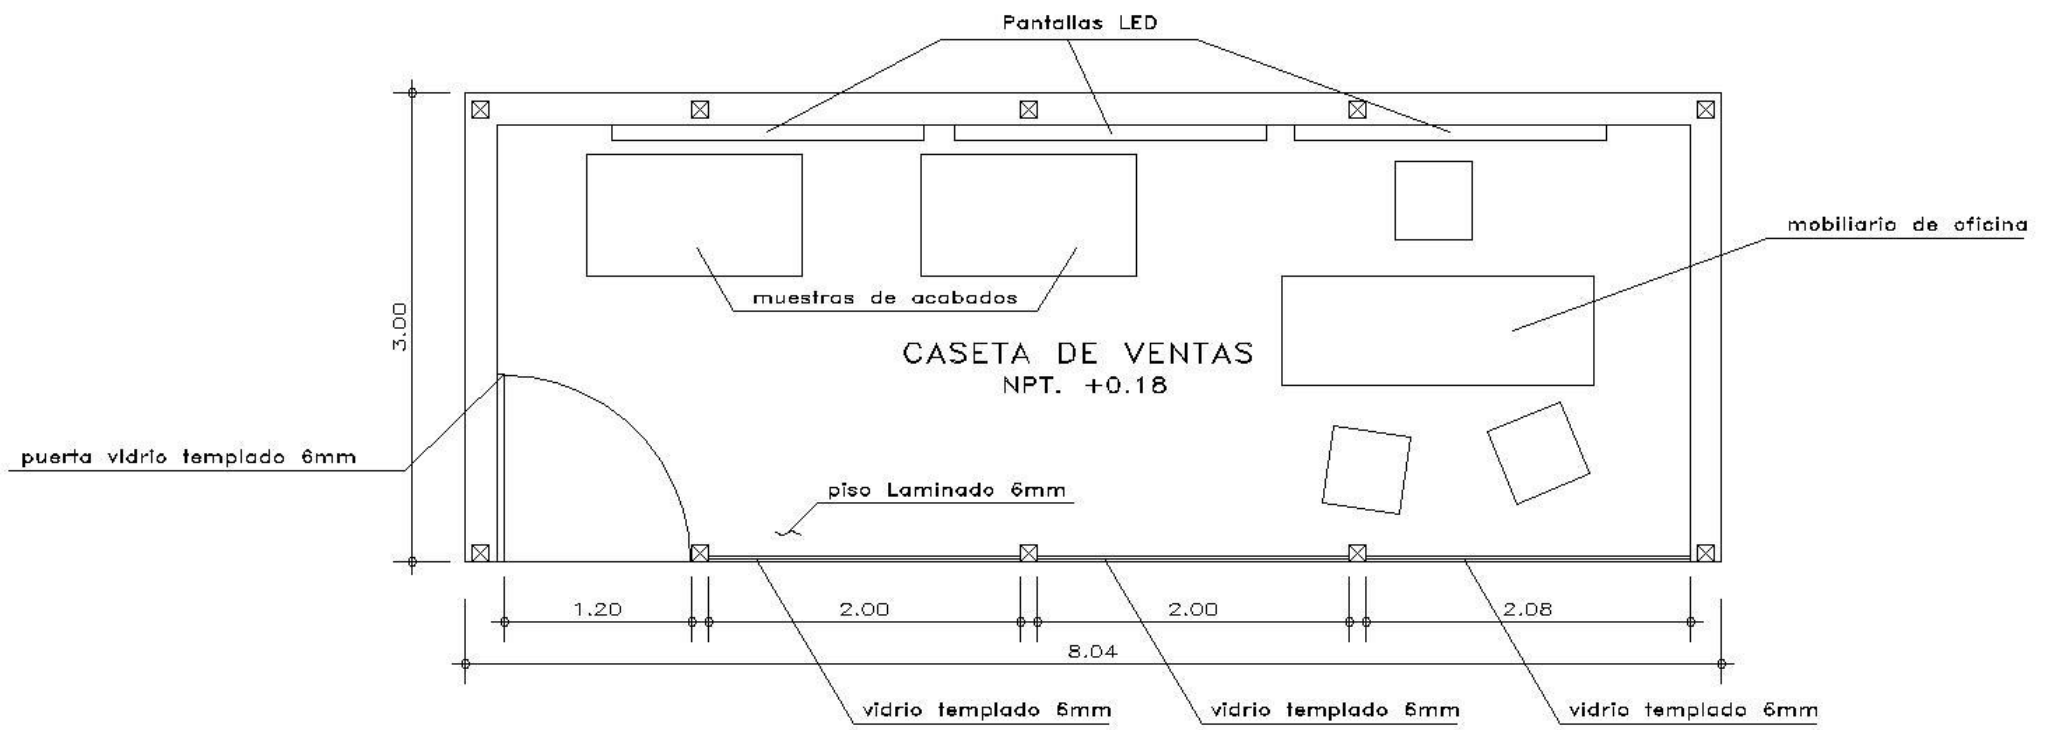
Plano de elevación y planta de caseta de ventas.
